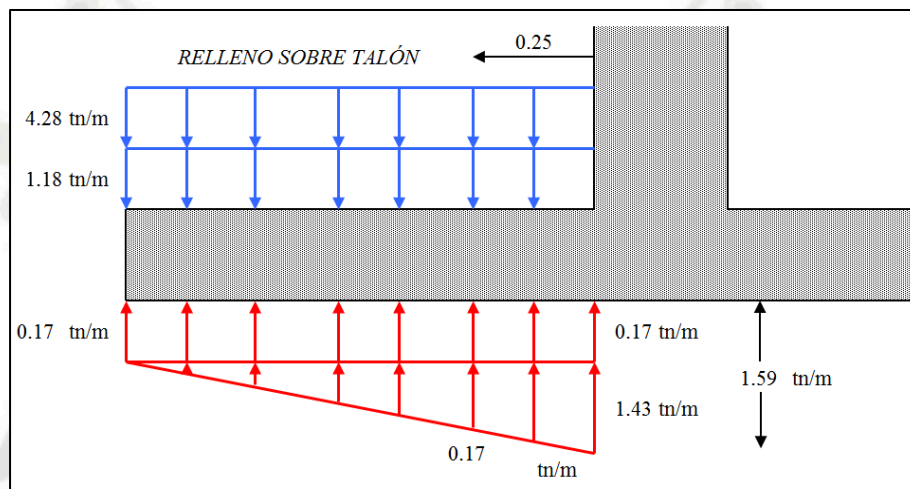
Esquema de presiones actuantes sobre y debajo de la cimentación del talón del muro
